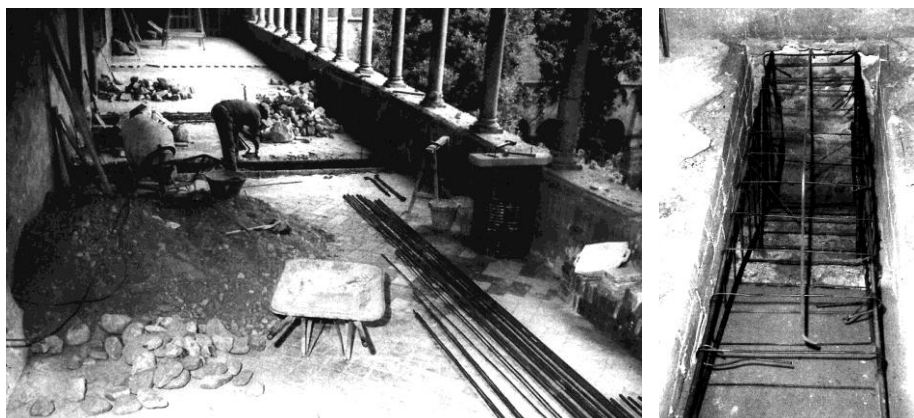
Monasterio de San Cugat del Vallés.. Consolidación del forjado entre galerías del claustro. Vista de la ejecución de la obra, detalle del armado de la viga embebida
